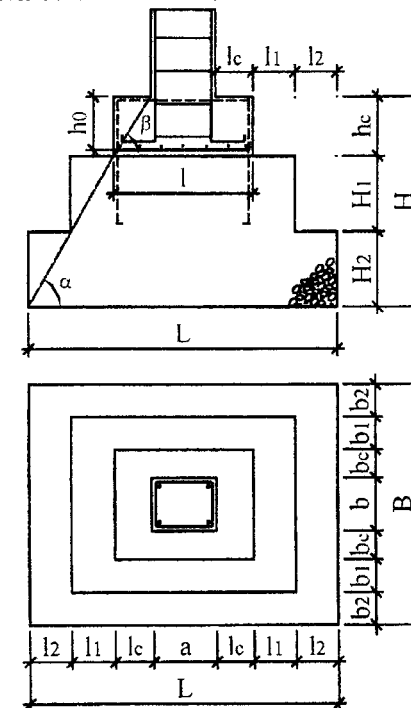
Fundație cu bloc din beton simplu și cuzinet din beton armat
